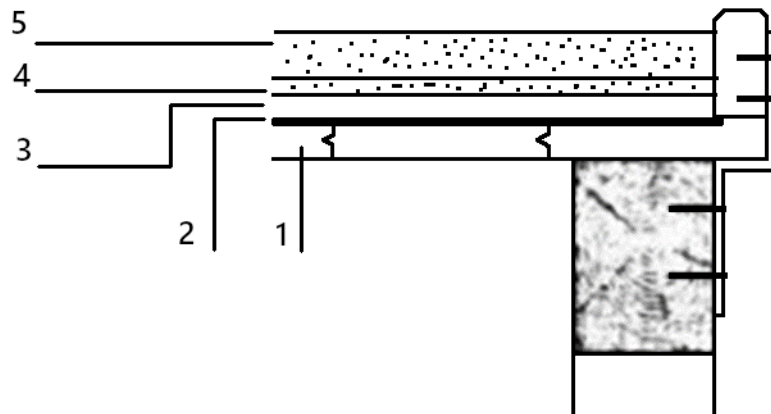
Detalle del sistema constructivo de Eduard Rüber. Leyenda: 1. Forjado de madera saturado con alquitrán; 2. Capa de cenizas; 3. Lámina impermeable (4 capas); 4. Arena; 5. Sustrato (150 mm).
